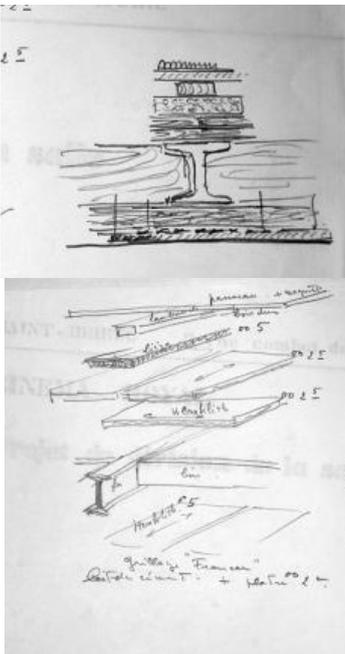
Croquis de la constitution du plancher - Source AD 22
